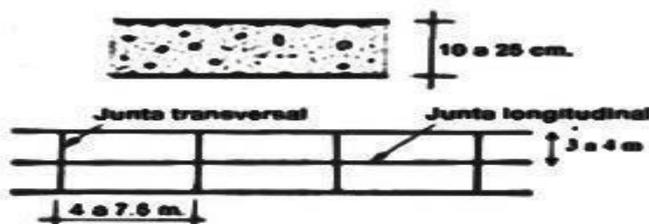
Pavimento concreto simple Fuentes: (Das, 2019)
